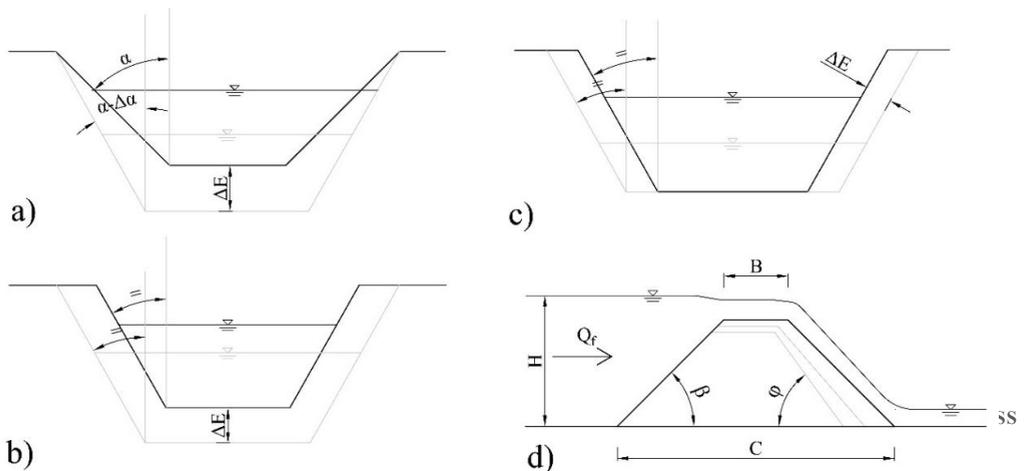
Modalità di erosione della sezione trapezia (a-b-c); sezione longitudinale (d) del terrapieno (da Sassu et al, 2017).
